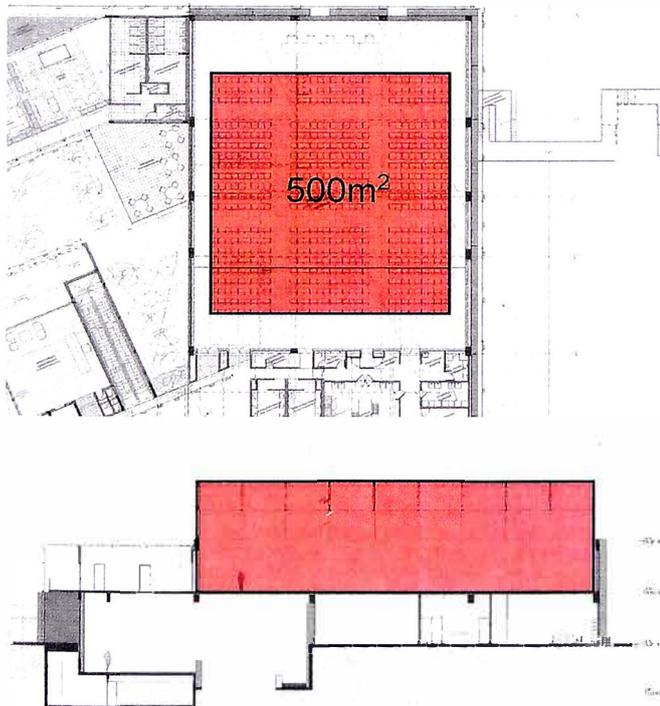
vista de planta área de invitados y corte general del SUM.
